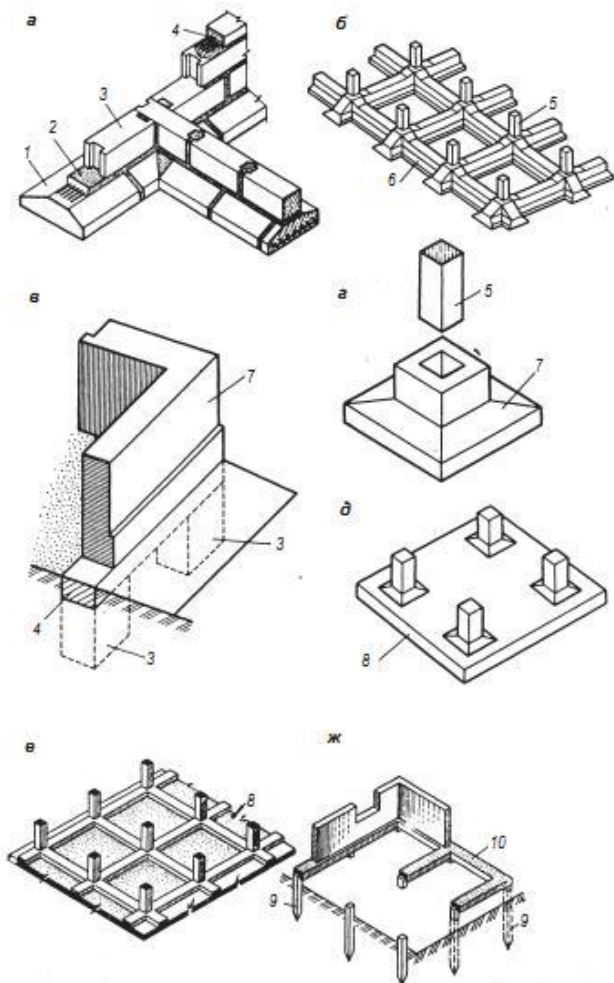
Конструктивні схеми фундаментів: а - стрічковий під стіни; б - стрічковий під колону; в - стовпчастий під стіни; г - стовпчастий під колону; д - суцільний безбалковий; е - суцільний балковий; ж- пальовий; 1 - фундамента плита; 2 - армований шов; 3 - бетонний стіновий блок; 4 - армований пояс; 5 - колона; 6 - залізобетонна стрічка; 7,8 - плита; 9 - паля; 10 - ростверк
